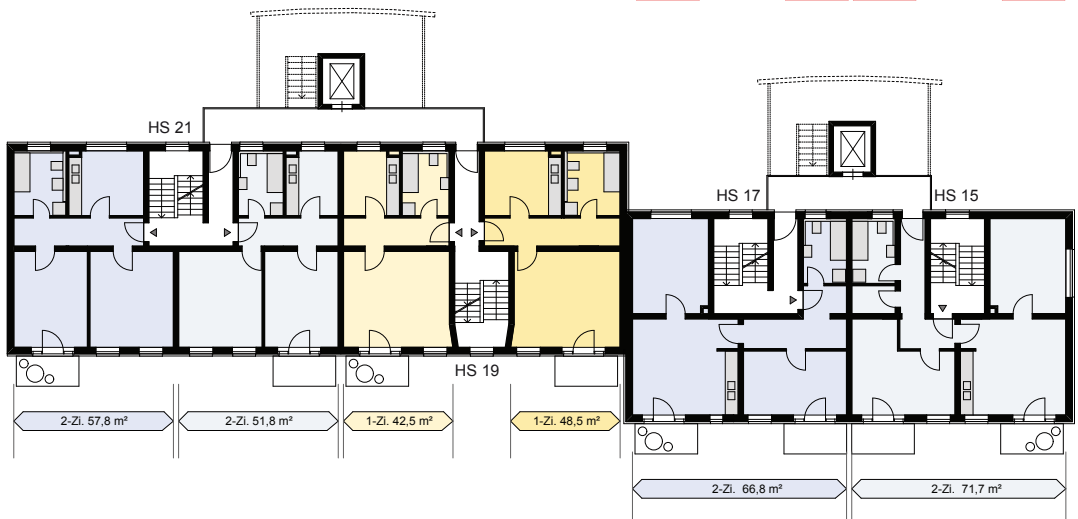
Grundrisse München, Hinterbärenbadstraße 15–21
